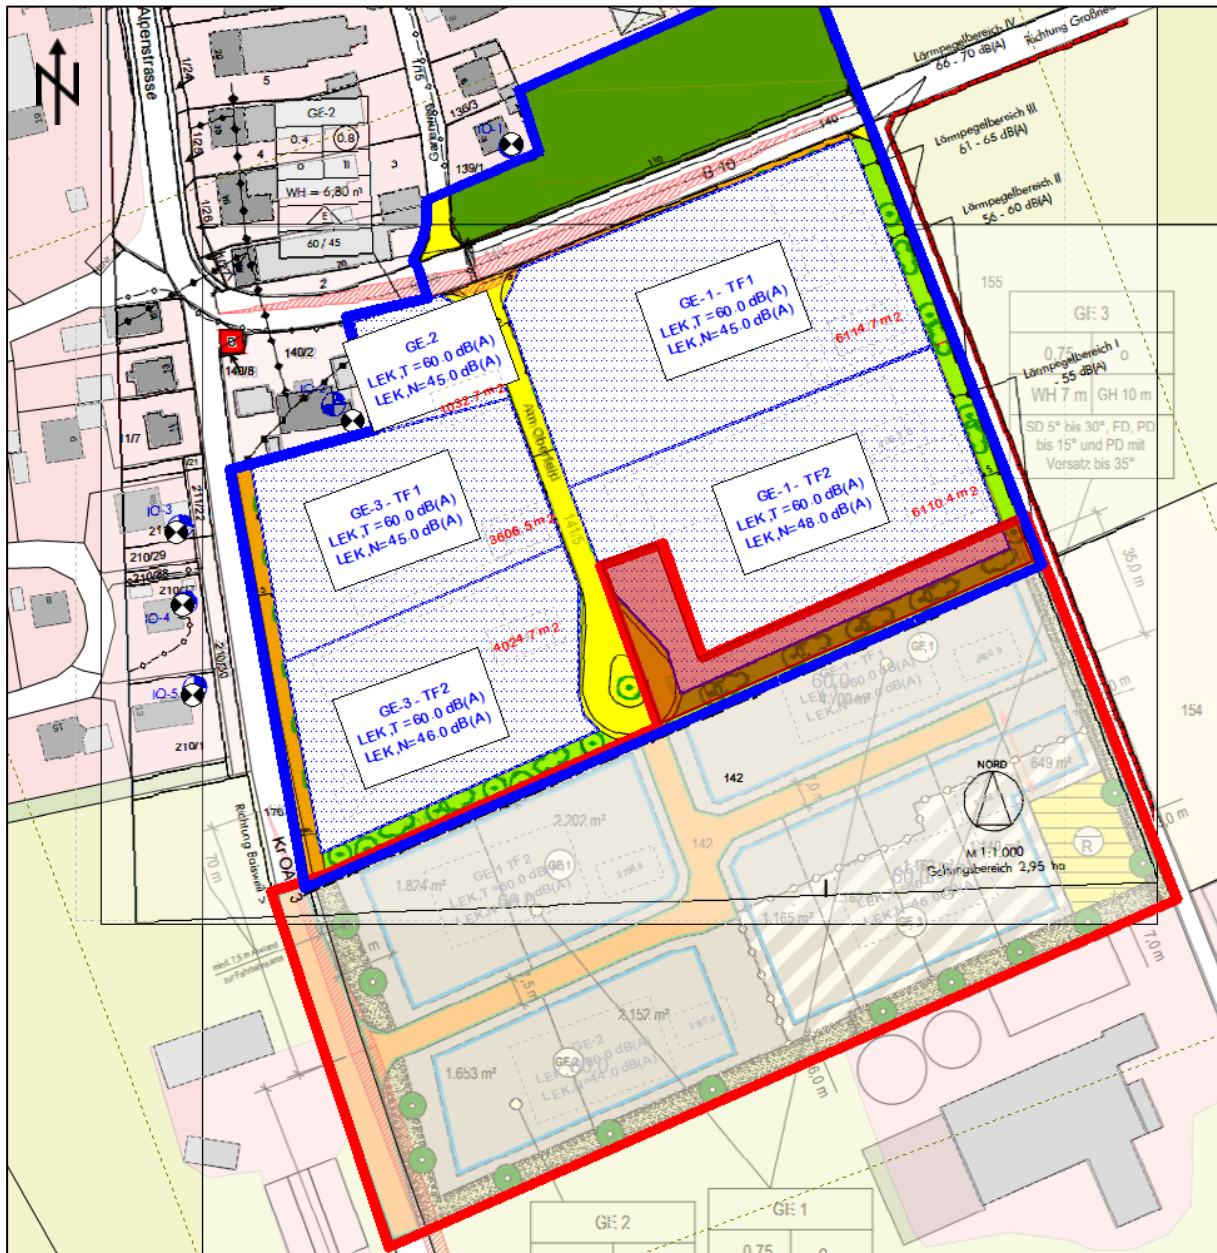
Räumliche Überlagerung der Bebauungspläne; die rot dargestellte Fläche zeigt den Überlagerungsbereich, der zu einer Reduzierung der kontingentierten Teilfläche GE-1, TF2 führt.
